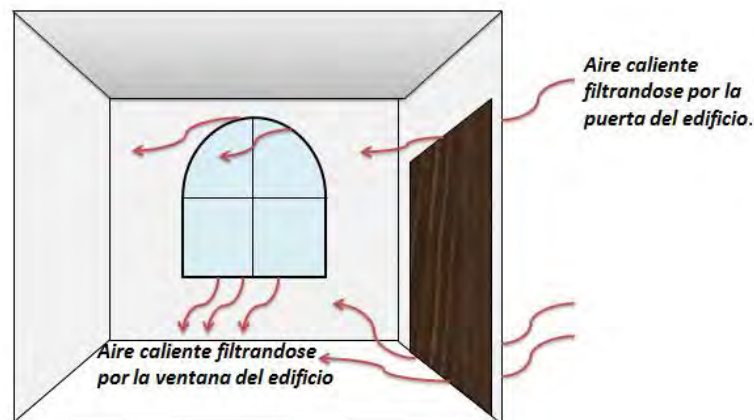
Filtración de aire por fisuras o aperturas de puertas.
